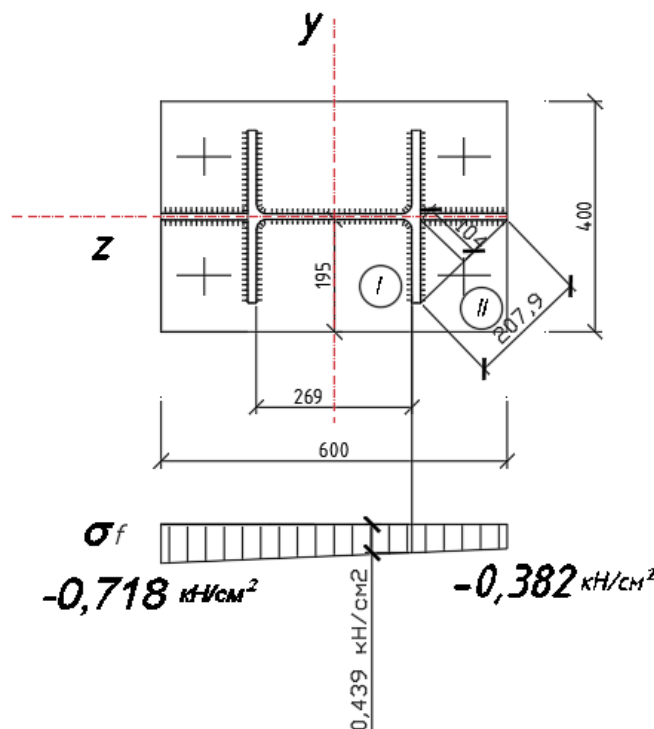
К определению напряжений в бетоне фундамента под плитой
